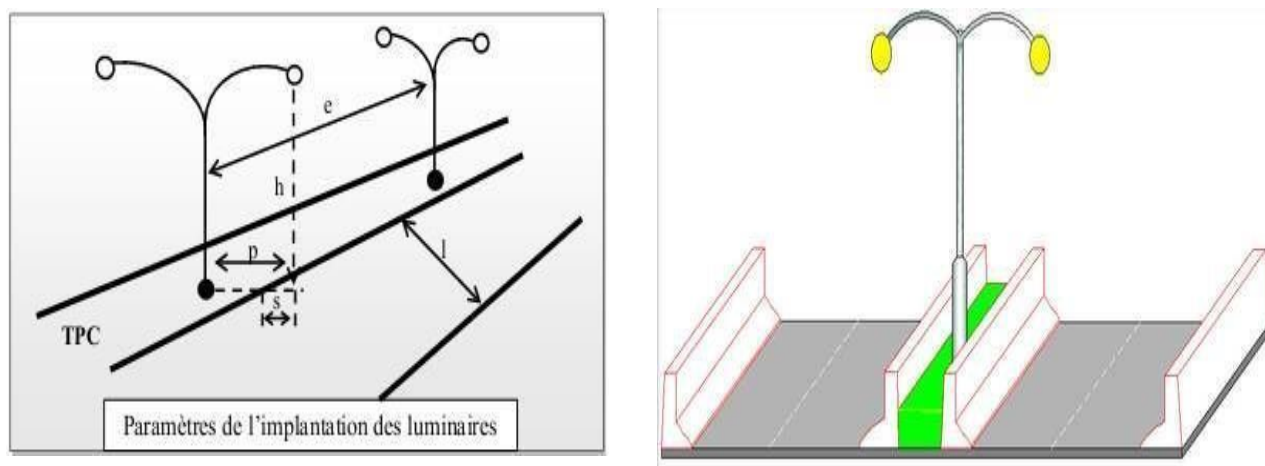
Les paramètres de l'implantation des luminaires.
